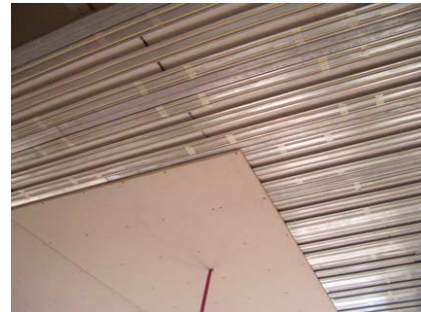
Progetto: sistema di riscaldamento a soffitto radiante con pannelli in cartongesso di protezione (immagine delle fasi di cantiere)
